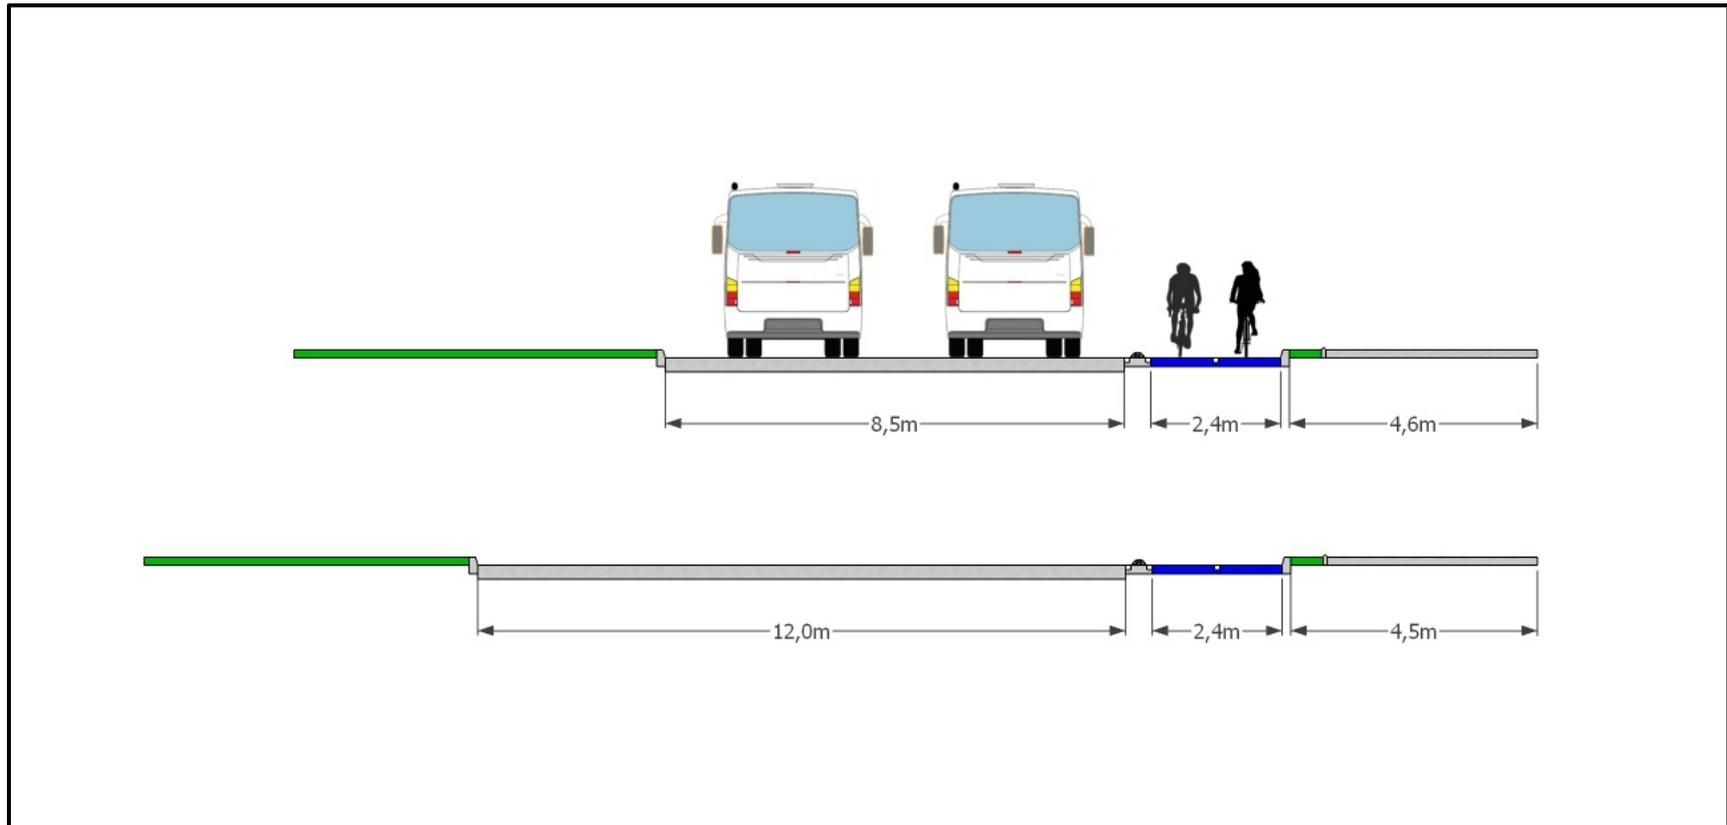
Nuevo Perfil Transversal Eje A (Av. España) / Sector A2 / 3 (antes-después)
